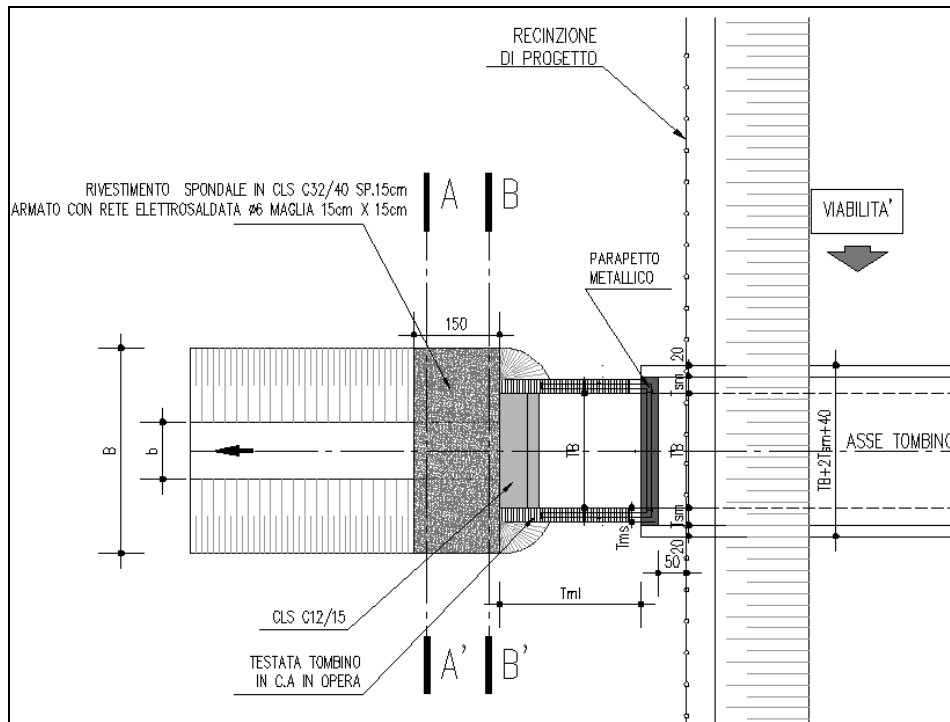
PLANIMETRIA IMBOCCO/SBOCCO ATTRAVERSAMENTI PRIVATI
